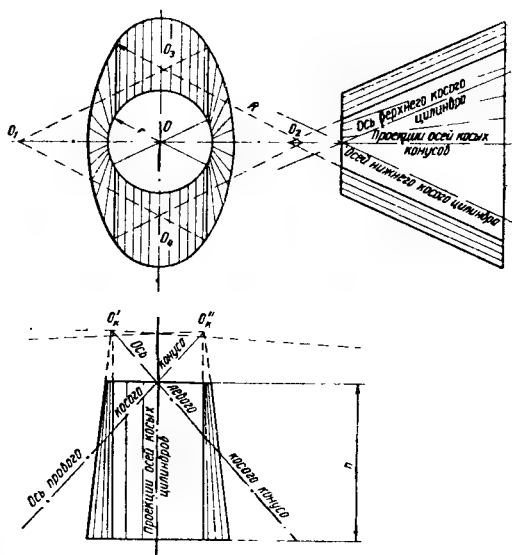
Разбивка трубопровода в месте перехода от кругового очертания к трехцентровому
